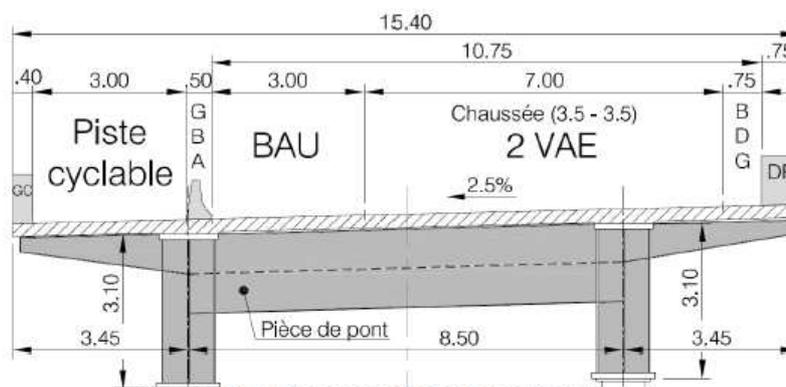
Coupe transversale sur appui de la solution C2-1
